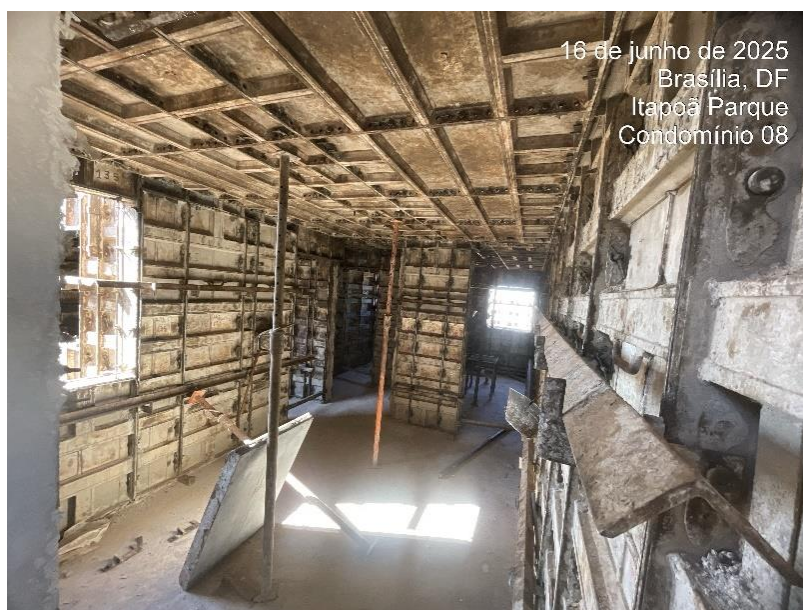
Execução de estrutura: Posicionamento final de fôrmas metálicas.
